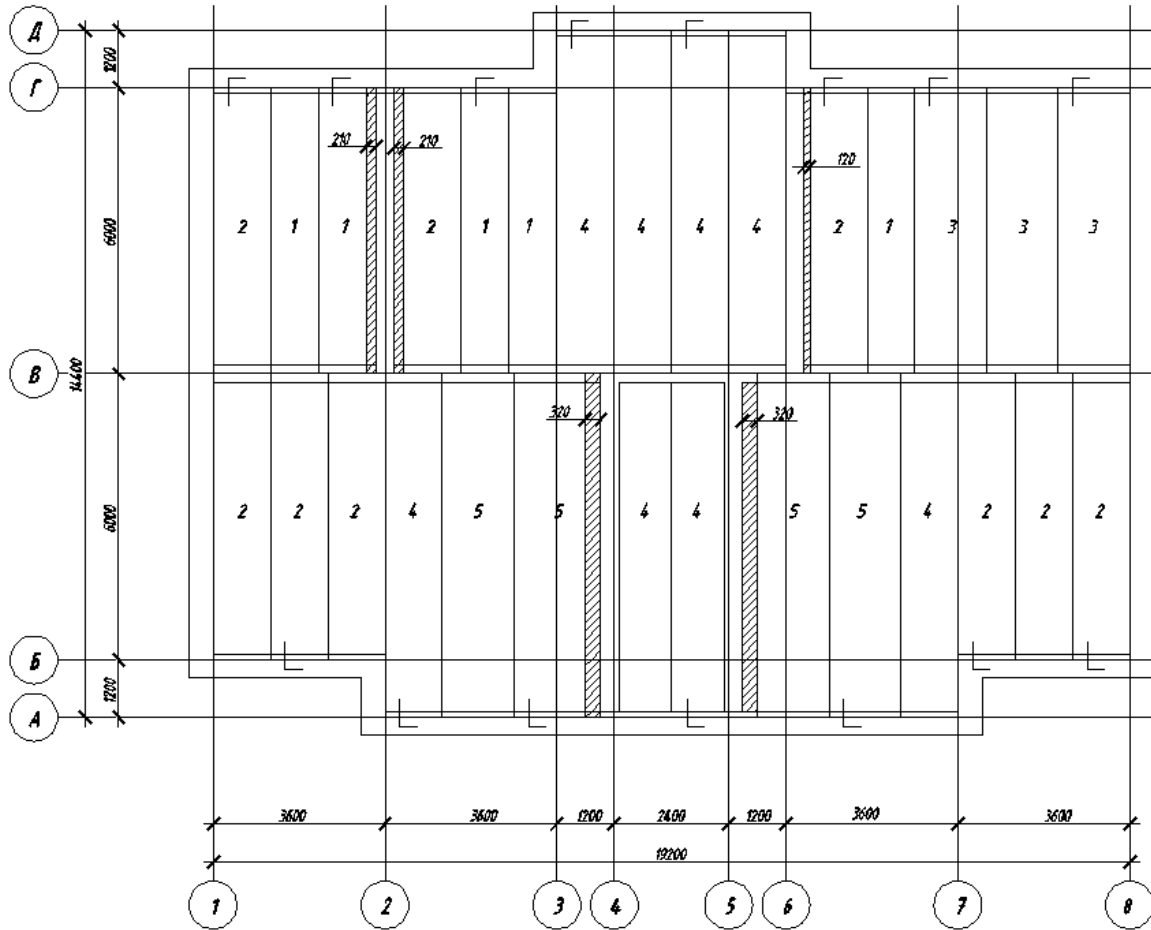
Раскладка плит перекрытий на отметке 5,500
